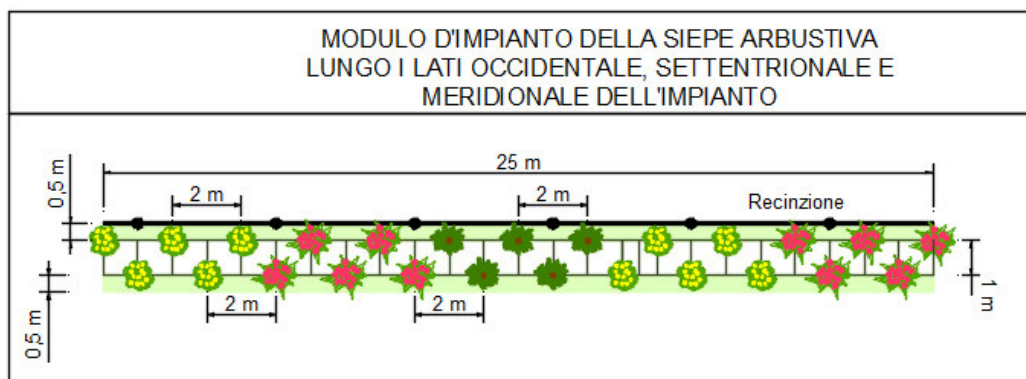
Schema d'impianto della siepe lungo il perimetro dell'area d'intervento.
